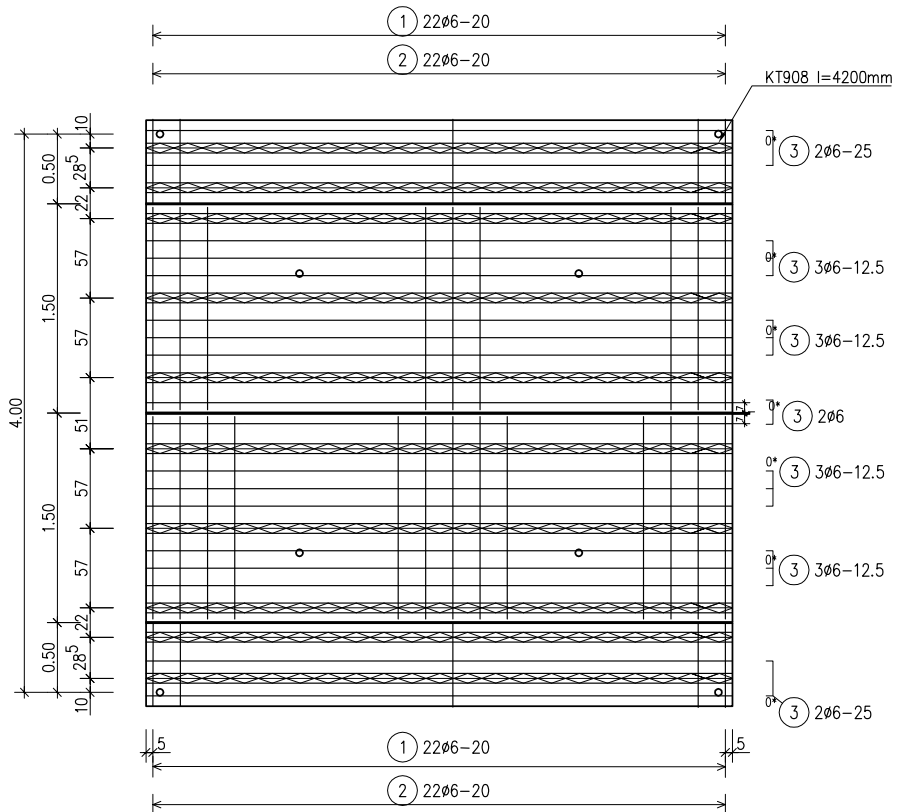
Platten 2 und 3, Bewehrung im Fertigteil, untere Lage
